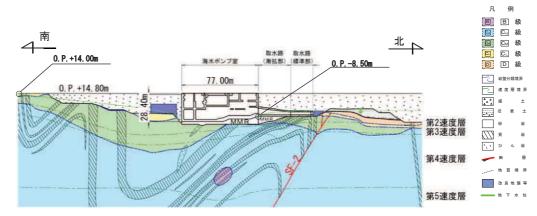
海水ポンプ室 地震時荷重算出用地質断面図 (D-D 断面,南北)
